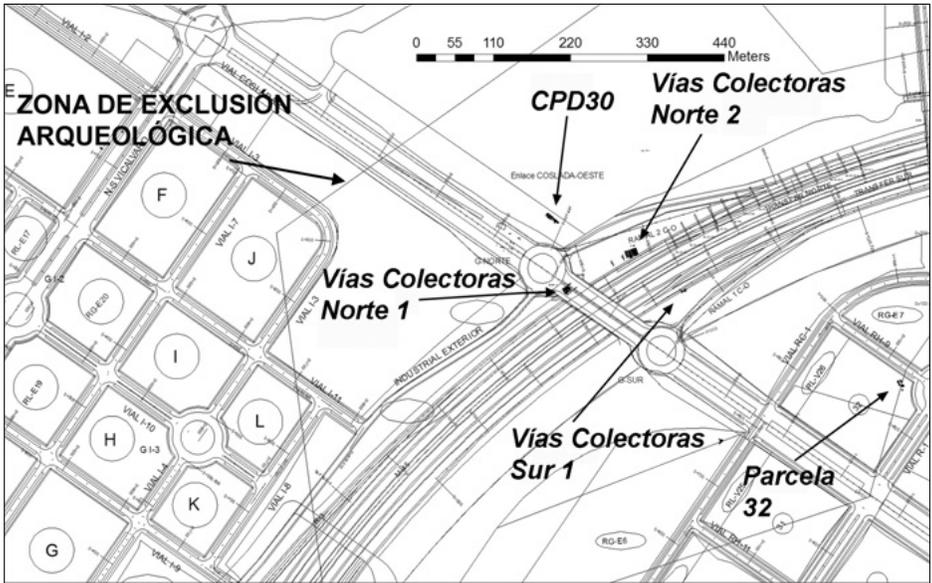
Plano de obra de El Cañaveral con indicación de las principales áreas excavadas.
